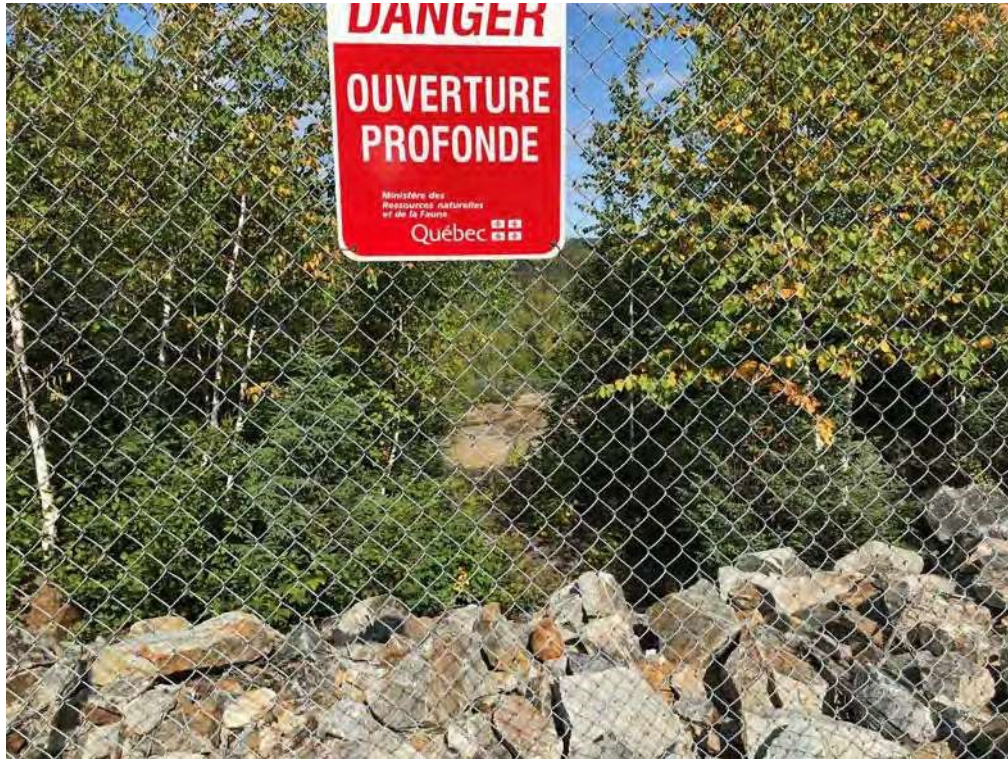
Clôture ceinturant la fosse n° 2 au sud
